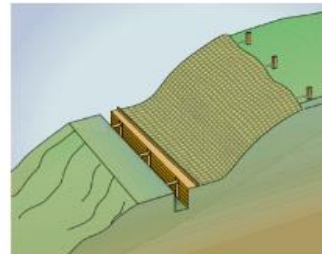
Escavação aberta - com passeio em talude e com paredes protegidas por cortinas
